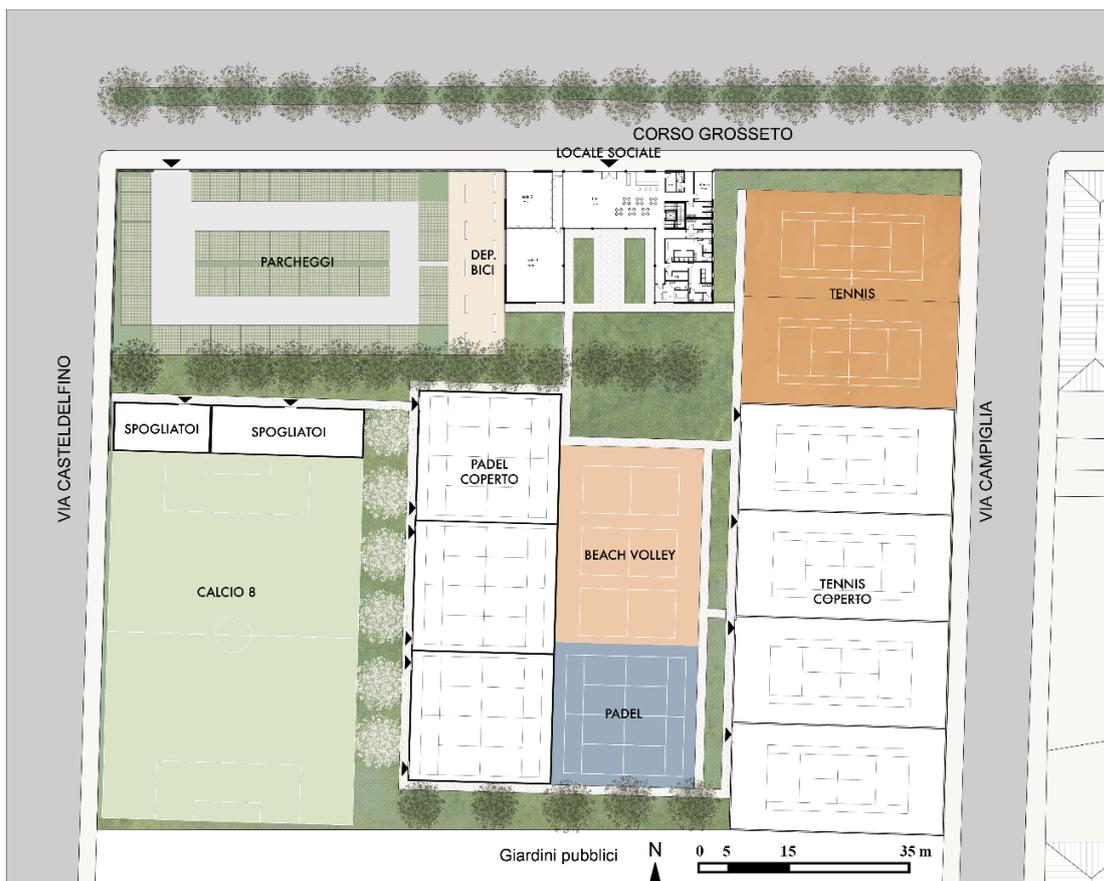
Elaborazione grafica dell'impianto planimetrico dell'area di progetto che ospiterà il nuovo centro sportivo in scala 1:500
